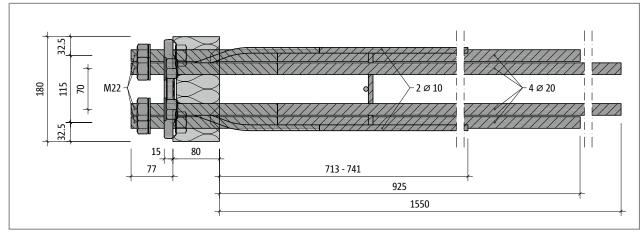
Schöck Isokorb® T type SK-MM2-VV1: Plan view
